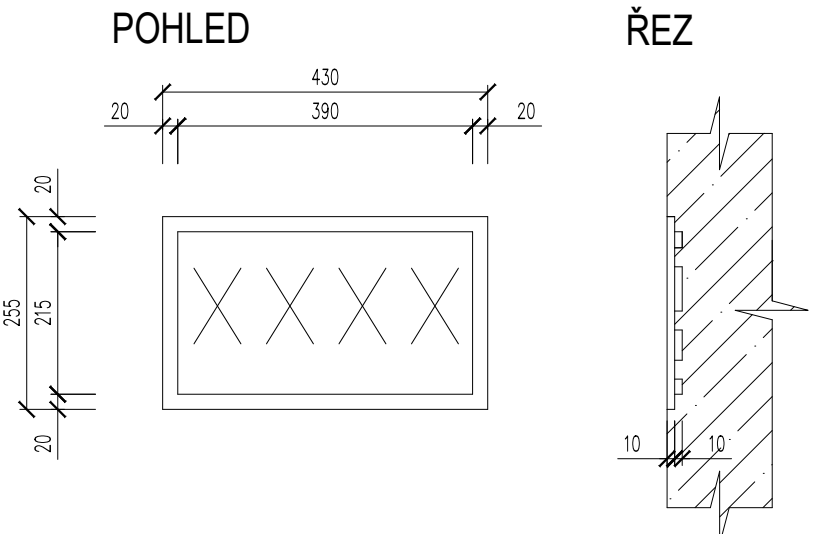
DETAIL ODVODNĚNÍ IZOLACE M 1:10
